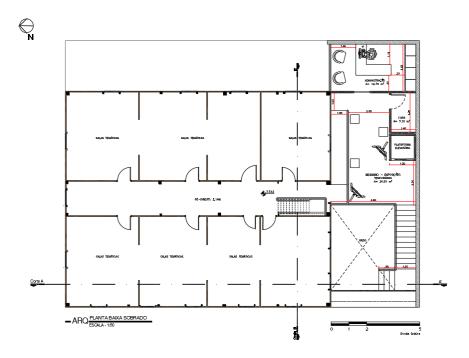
Planta baixa primeiro pavimento. Fonte: Arq. Urb. Me. Adilson Giglioli.
